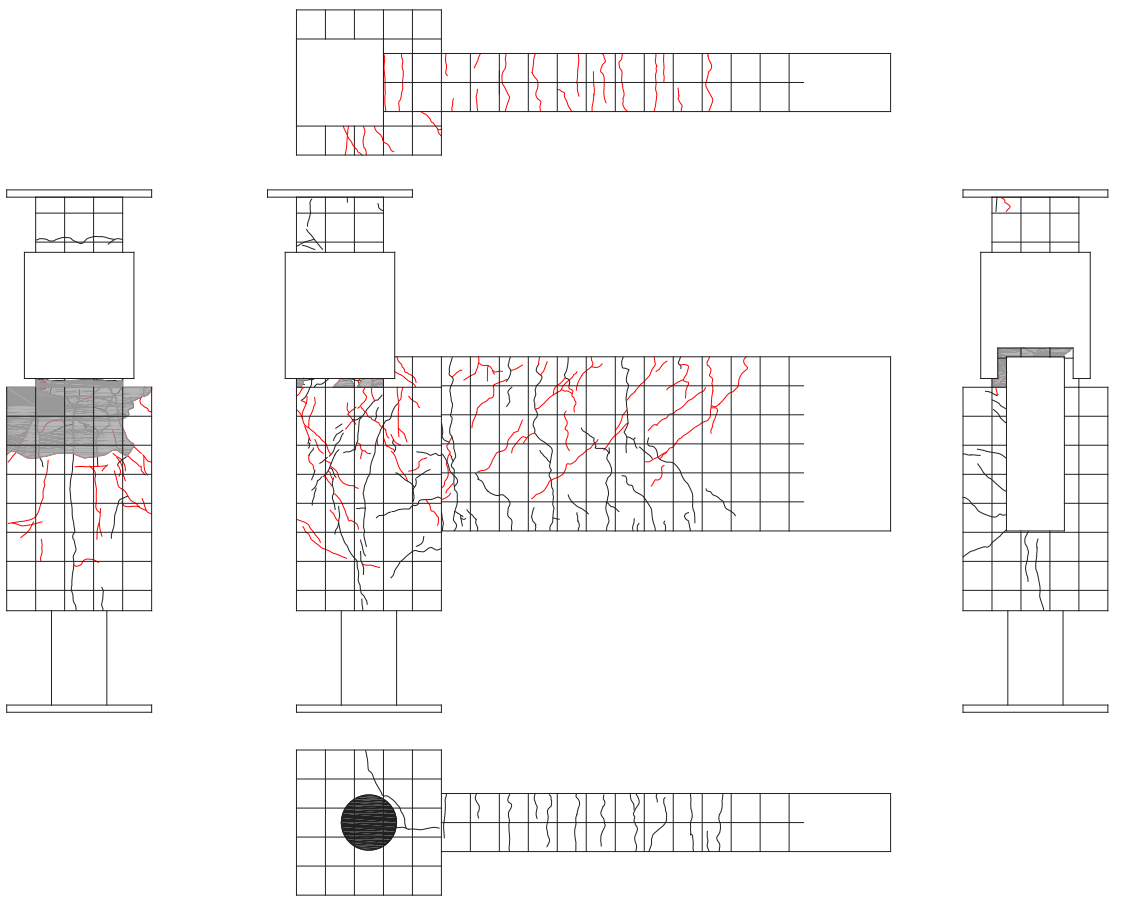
3. 99 試験体 C-2 ひび割れ状況 (8Cycle)
